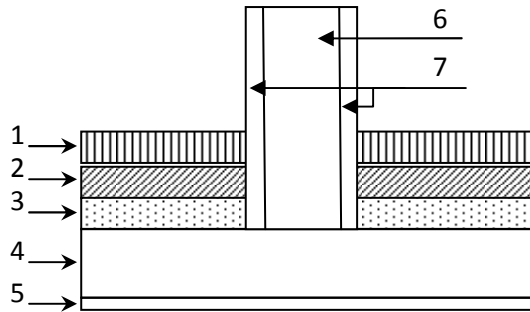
Coupe verticale d'un plancher terrasse
